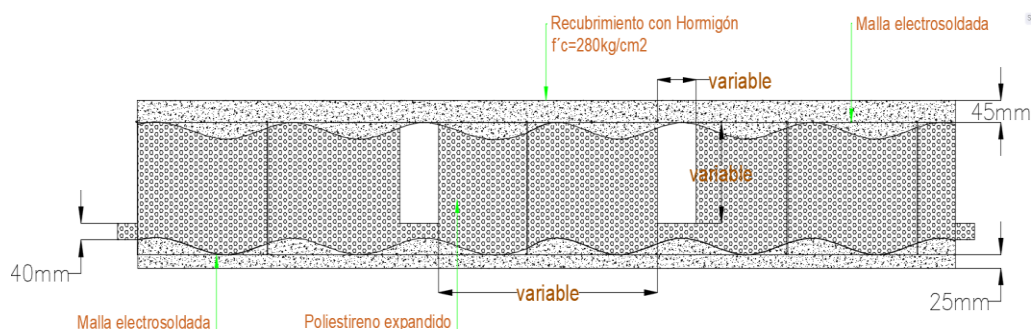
Sección típica Panel Losa estructural 3 nervaduras
